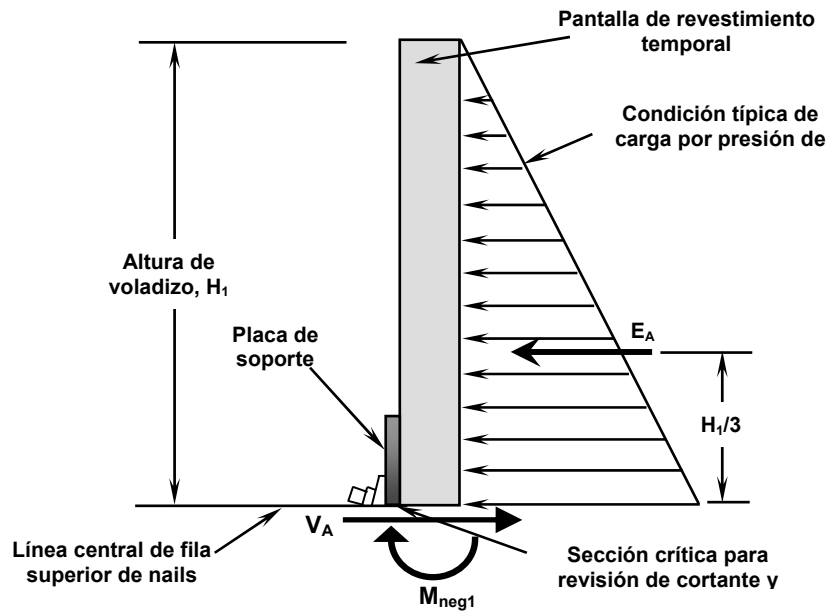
Voladizo de un muro Soil Nailing bajo condición estática.
